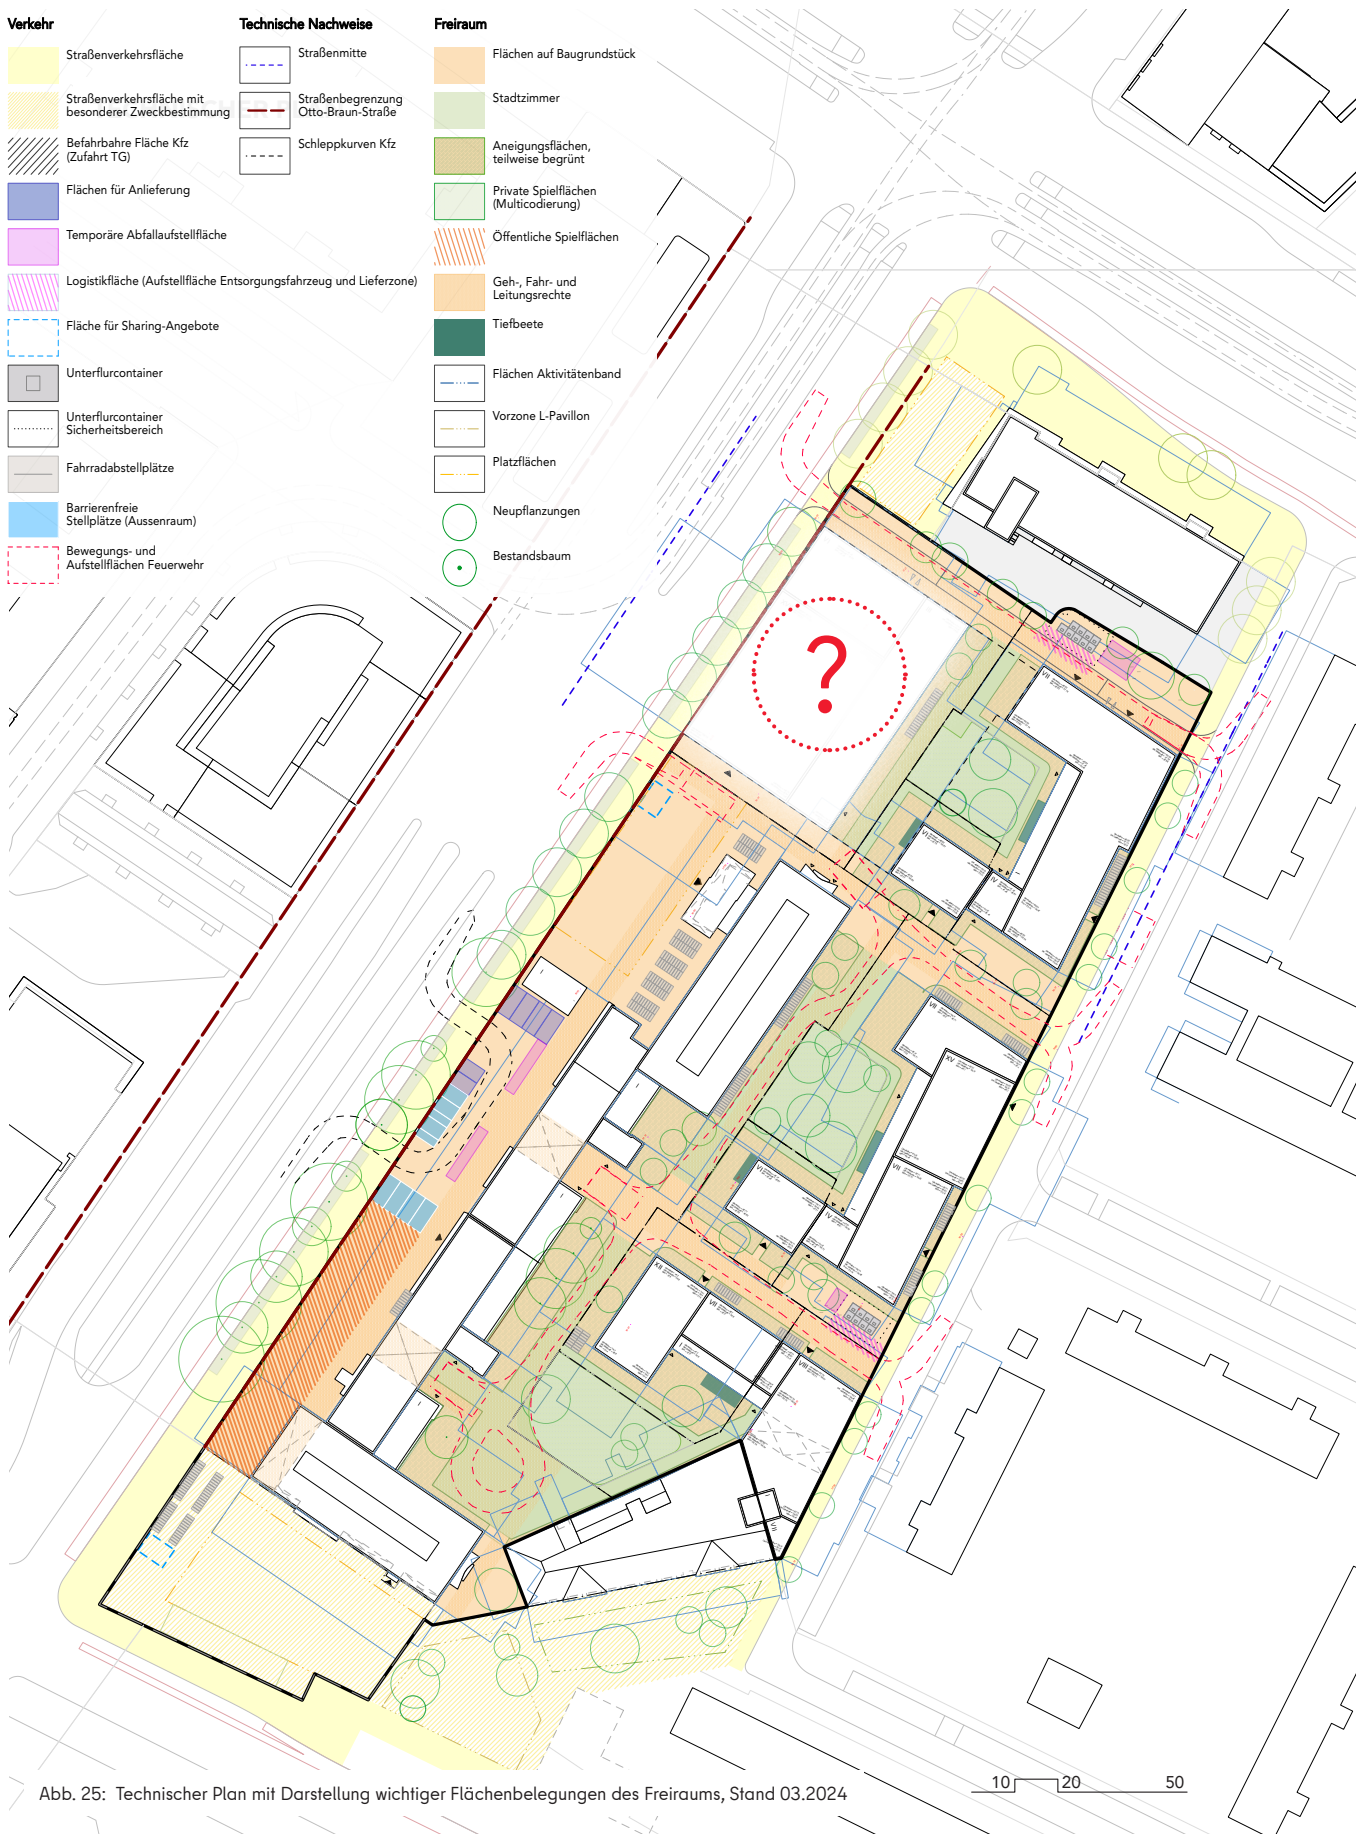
Technischer Plan mit Darstellung wichtiger Flächenbelegungen des Freiraums, Stand 03.2024
